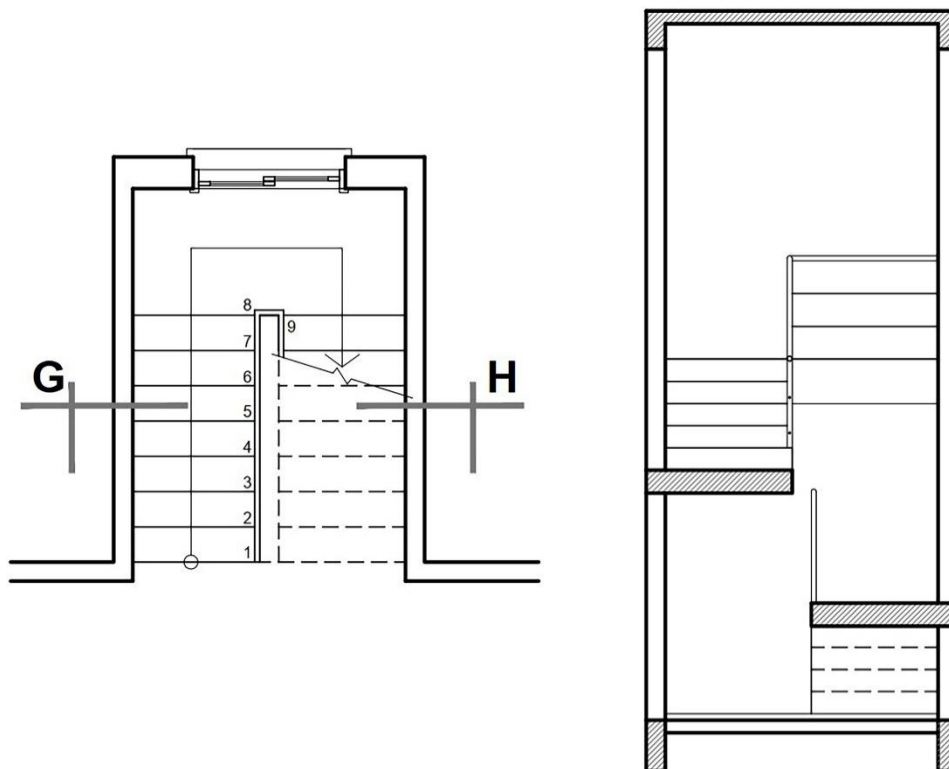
Alteração na posição do plano de corte: plano perpendicular aos 1º e 2º lances.
